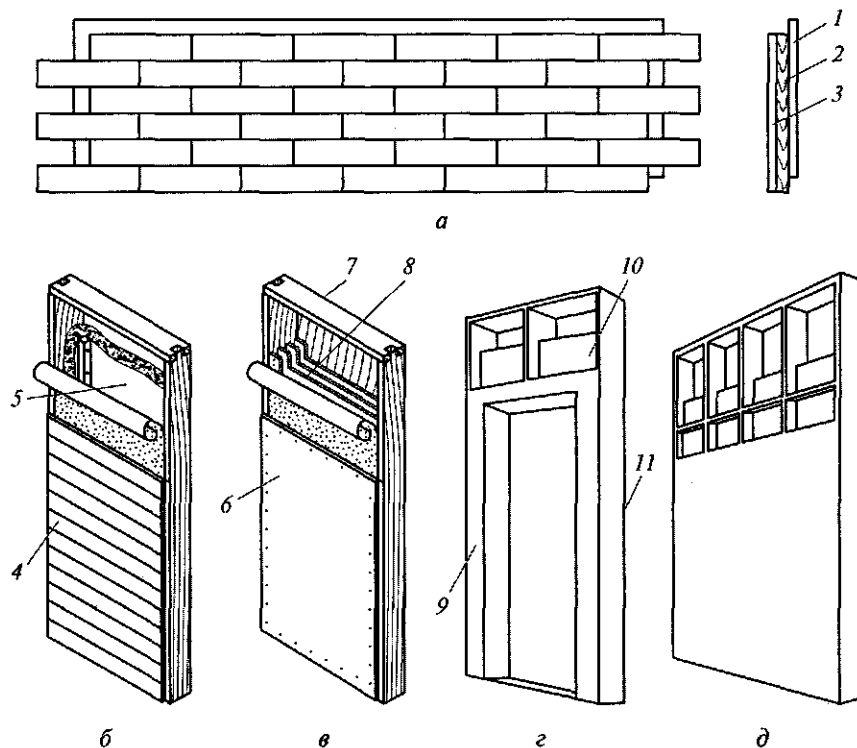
Способы дополнительной теплоизоляции наружных стен:
